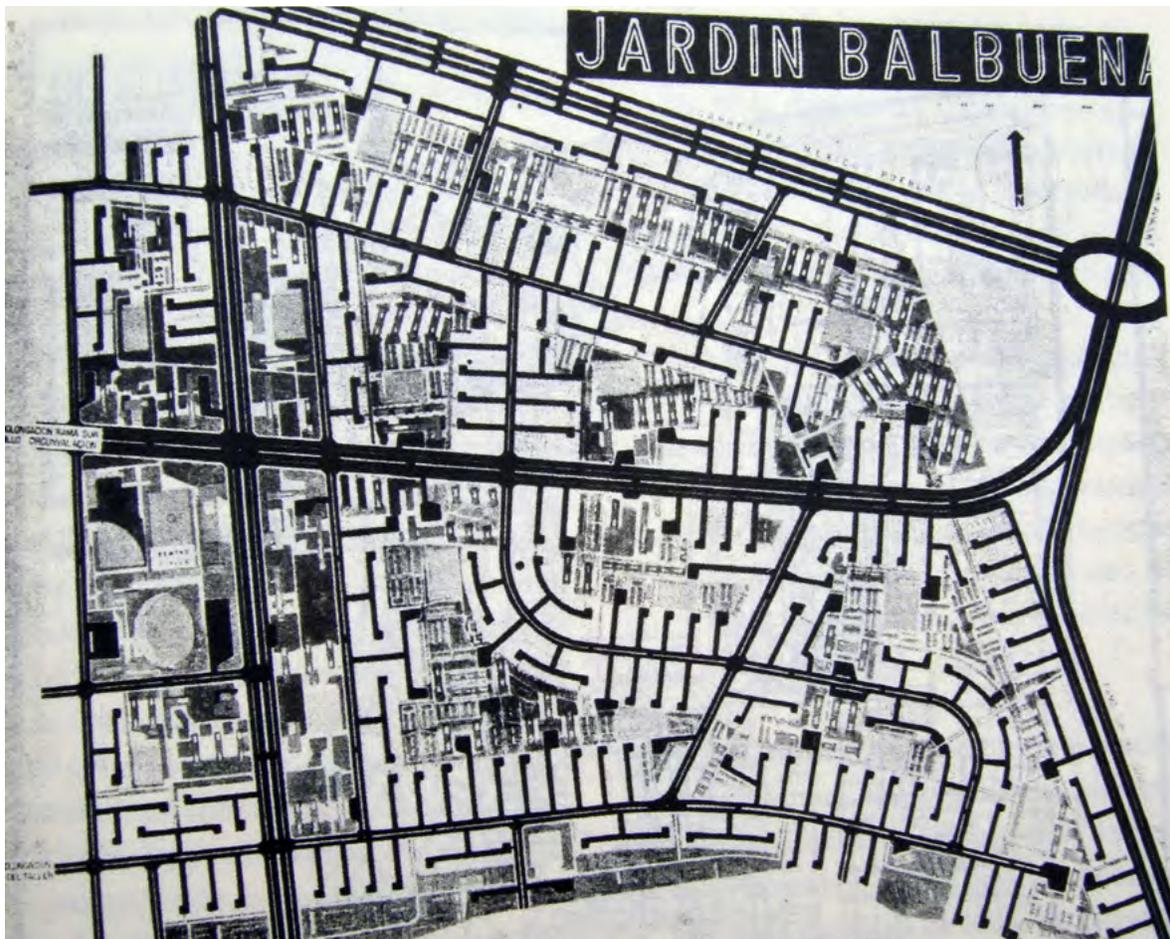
Jardín Balbuena, planta de conjunto arquitectónico.
